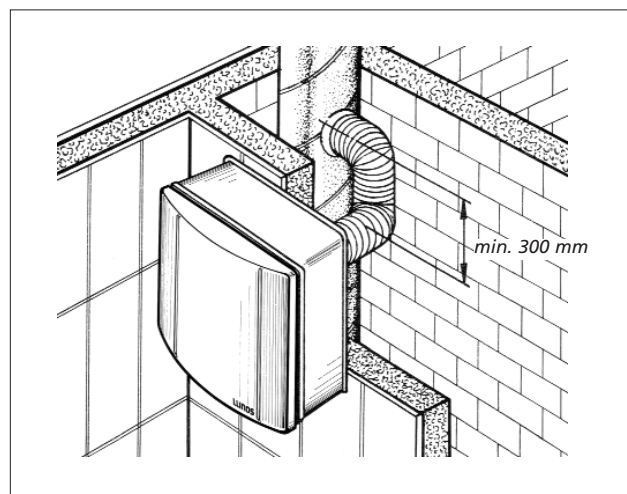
Omezení montáže v zóně 1 v koupelnách.
